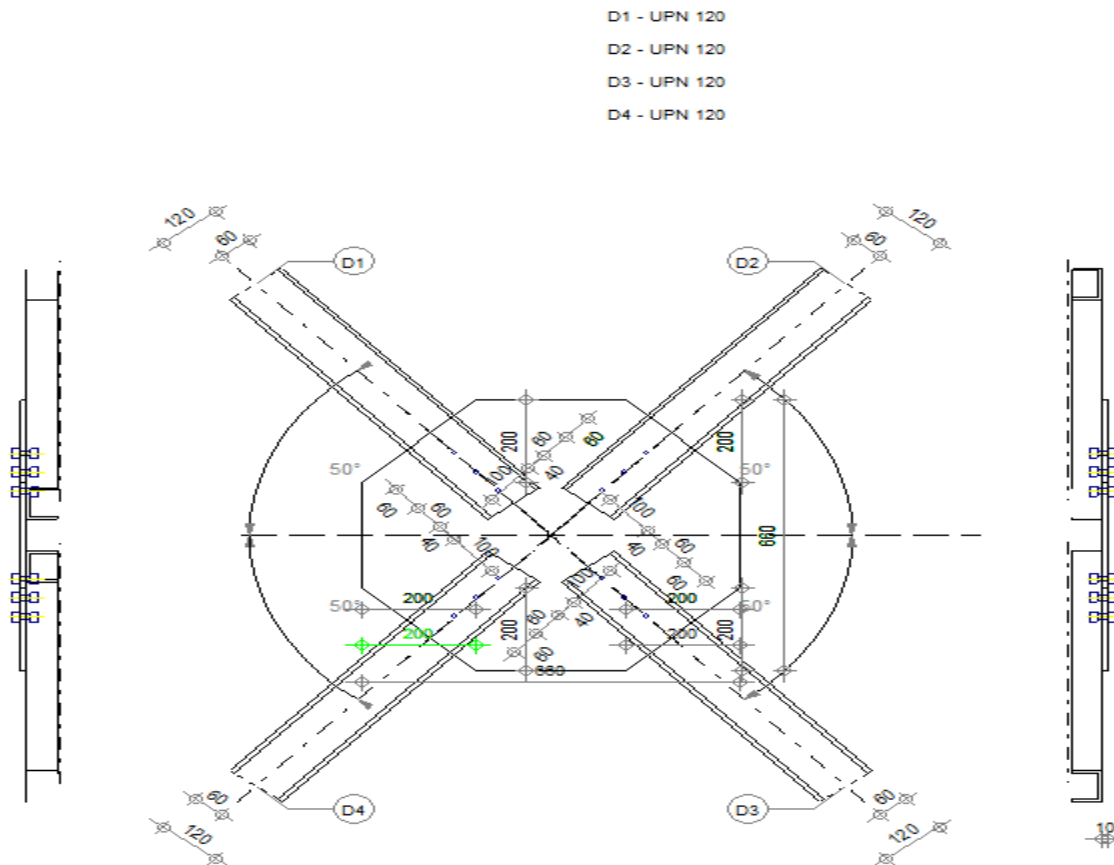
vue en plan de l'assemblage de la diagonale du palée de stabilité.
